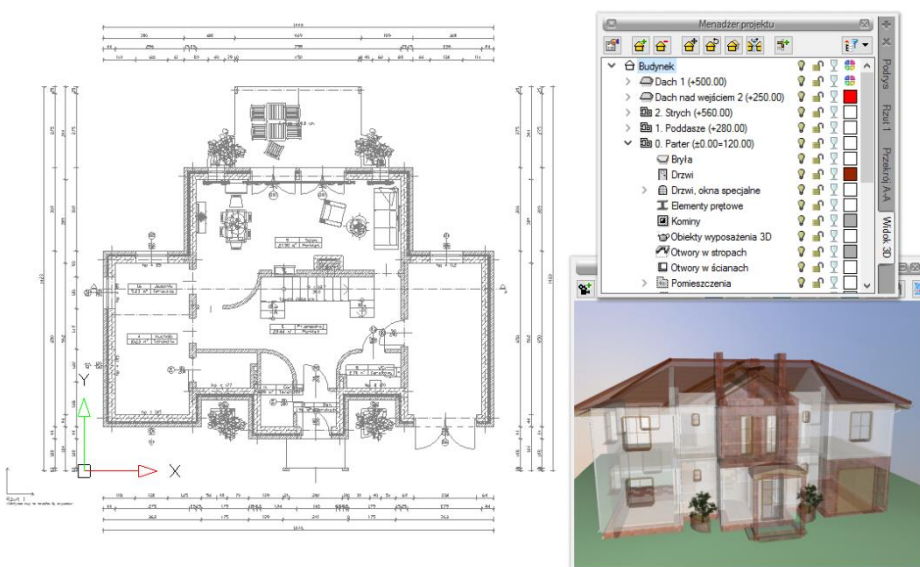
Przykład z aktywnym widokiem Widok 3D
